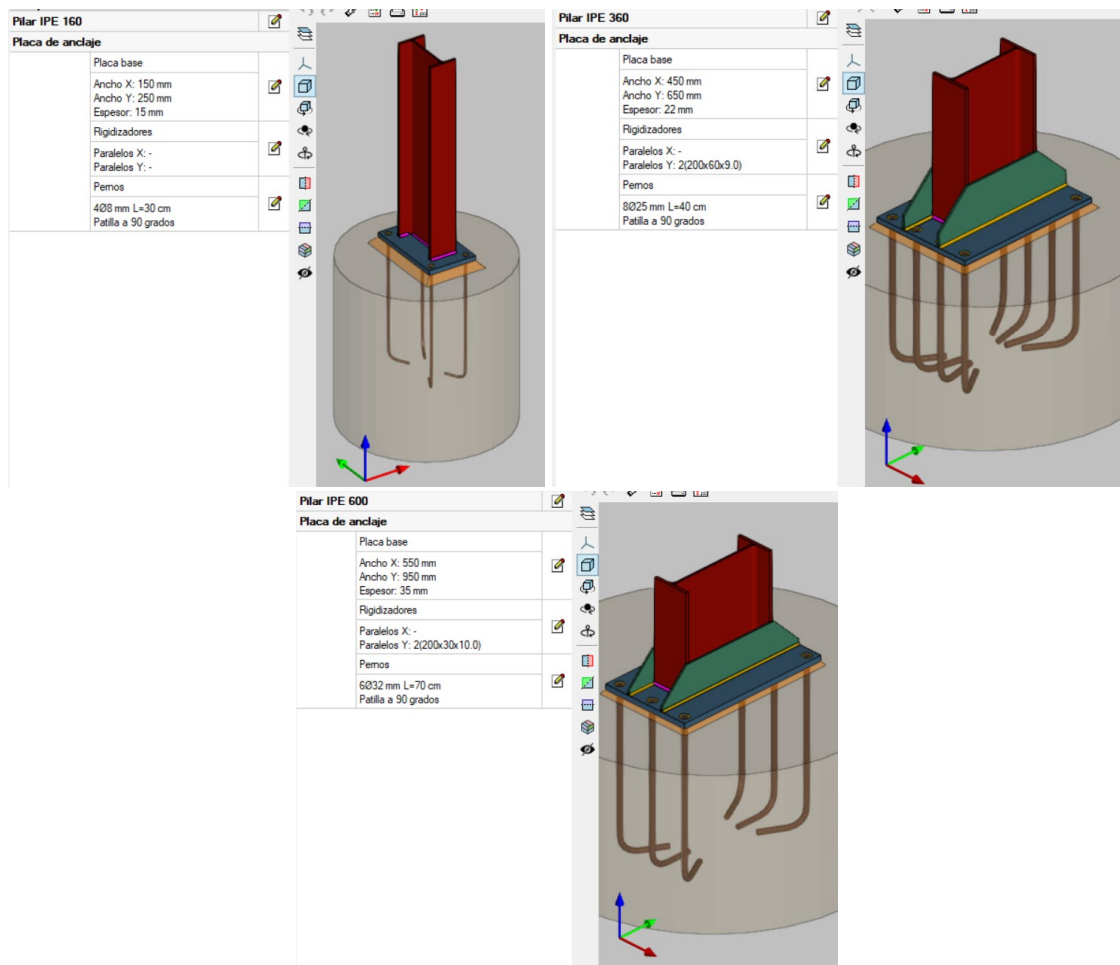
Detalles de los tres tipos de placa de anclaje presentes en el proyecto
